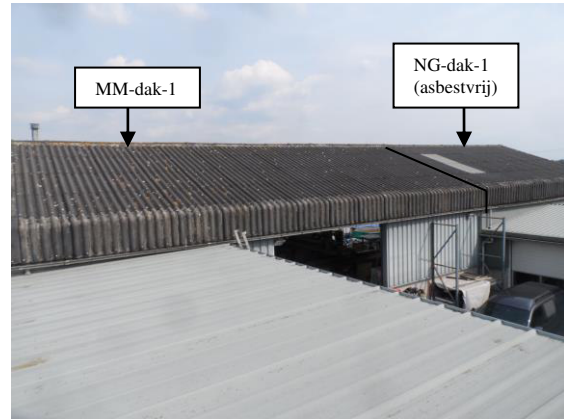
Geïntervieweerde kapconstructie/dakbedekking van de schuur met gedeeltelijk asbesthoudende en gedeeltelijk asbestvrije golfplaat als dakbedekking vanuit noordwestelijke richting gezien.
